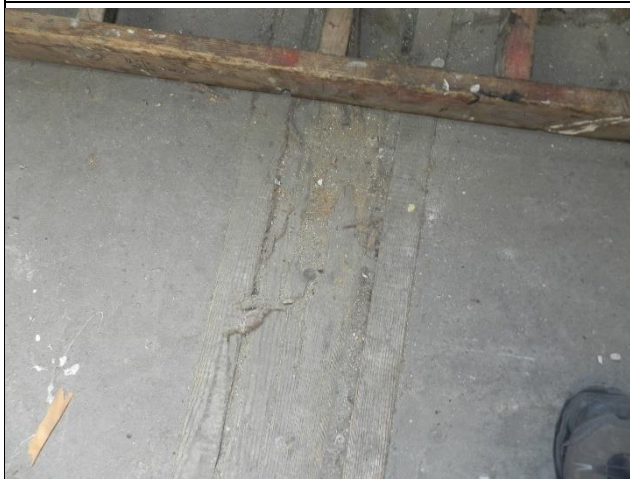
Widok pokrycia dachowego na części frontowej budynku.
